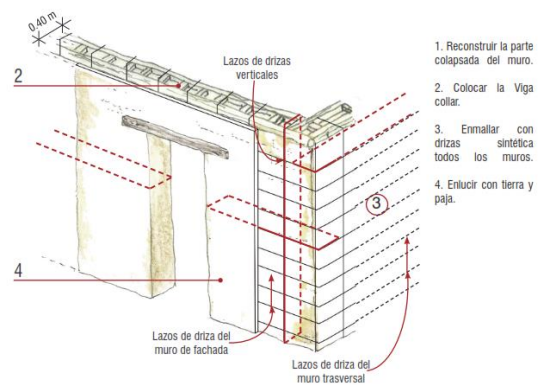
Para fisuras verticales en las esquinas se recomienda el amarrado con drizas o Geomallas que bordeen la zona afectada.
